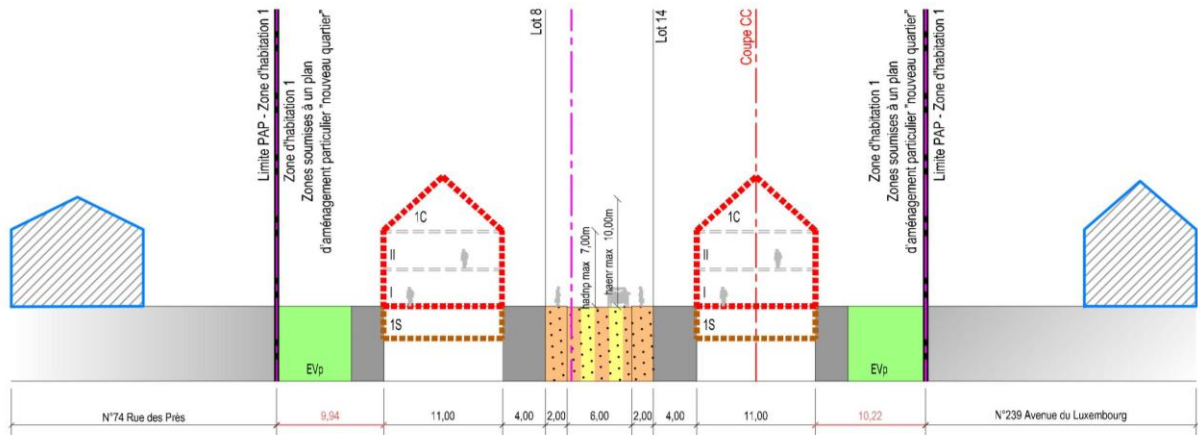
coupe A-A Type t2 (hors échelle)
